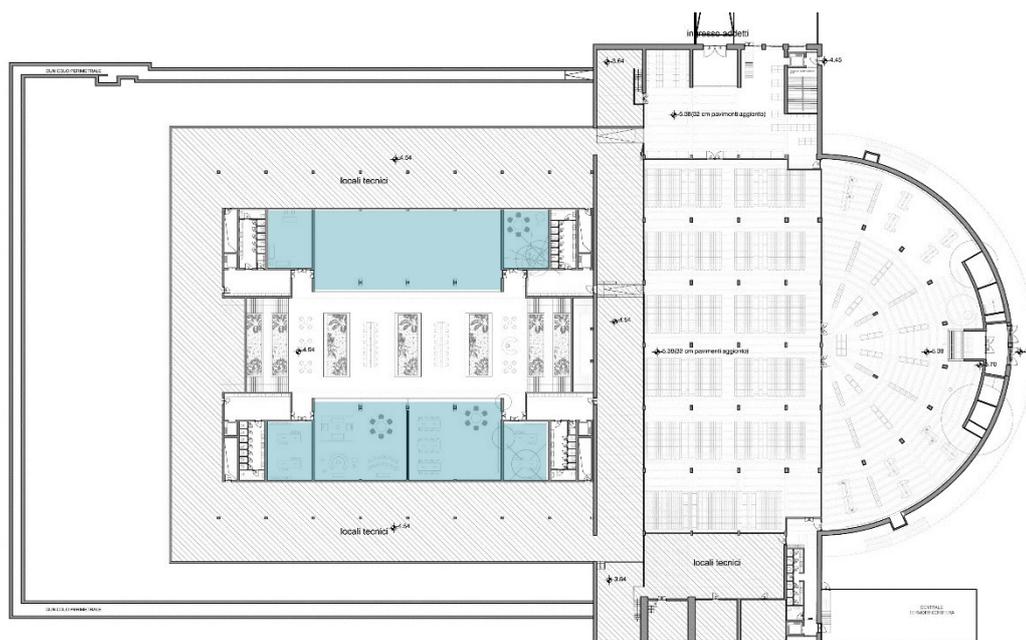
Pianta del piano interrato con indicazione degli ambienti con controsoffitto fonoassorbente.
